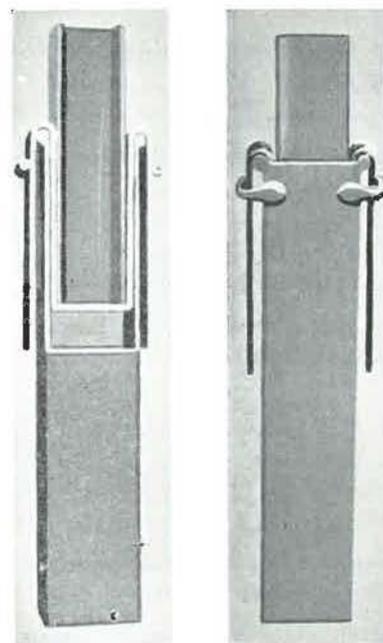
Coupe et vue d'un pied de cadre August Thyssen.
